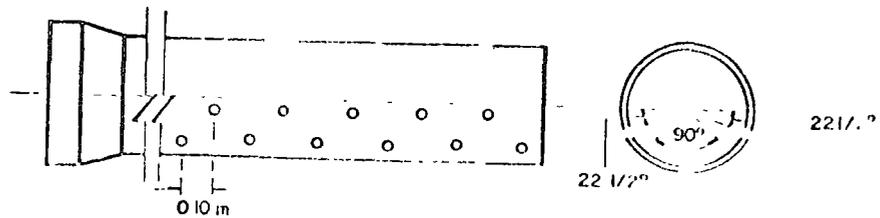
Disposición de las perforaciones en tuberías para subdrenaje.
